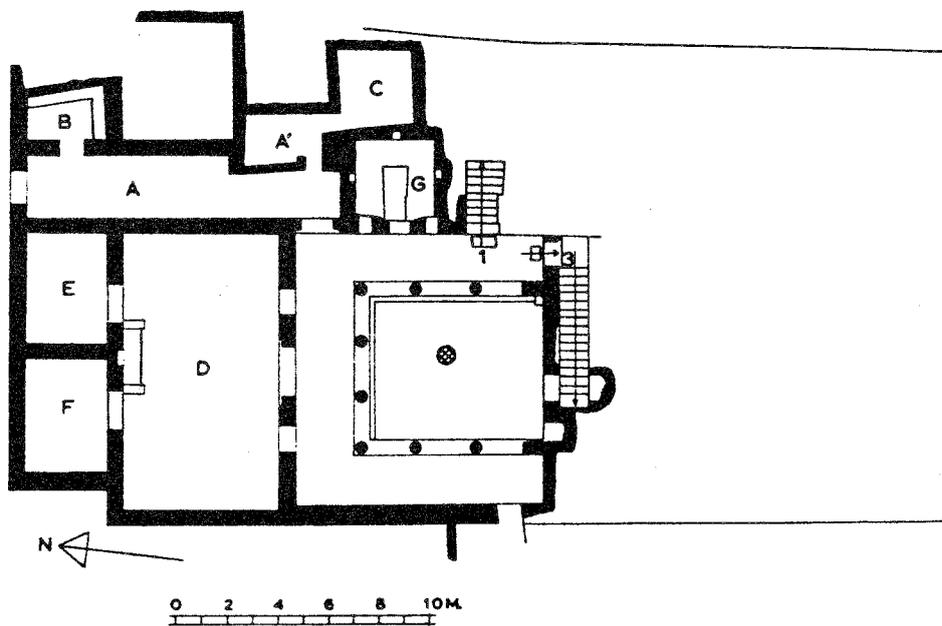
Plan du rez-de-chaussée de la Maison de l'hermès
